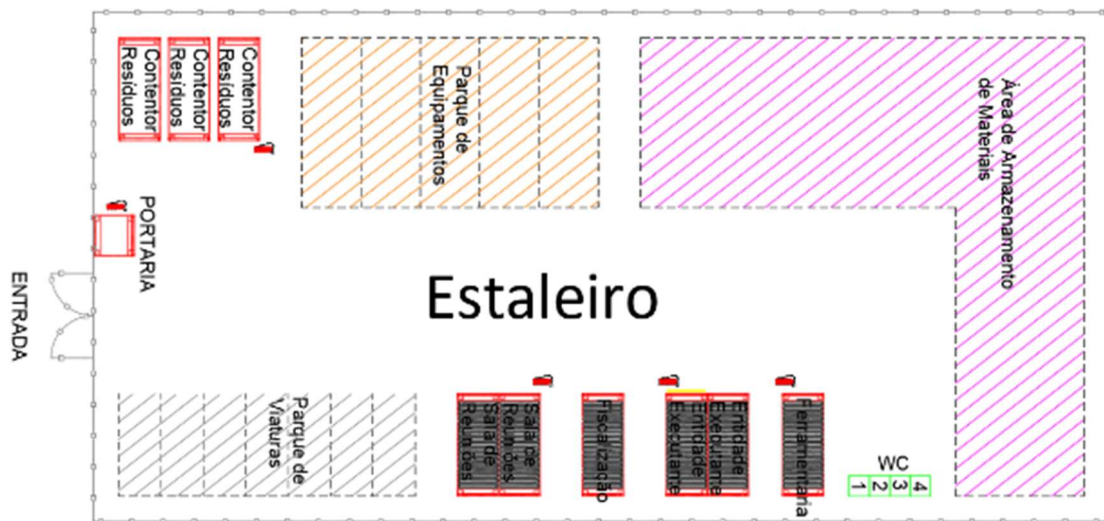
Exemplo da distribuição de um estaleiro em fase de construção
